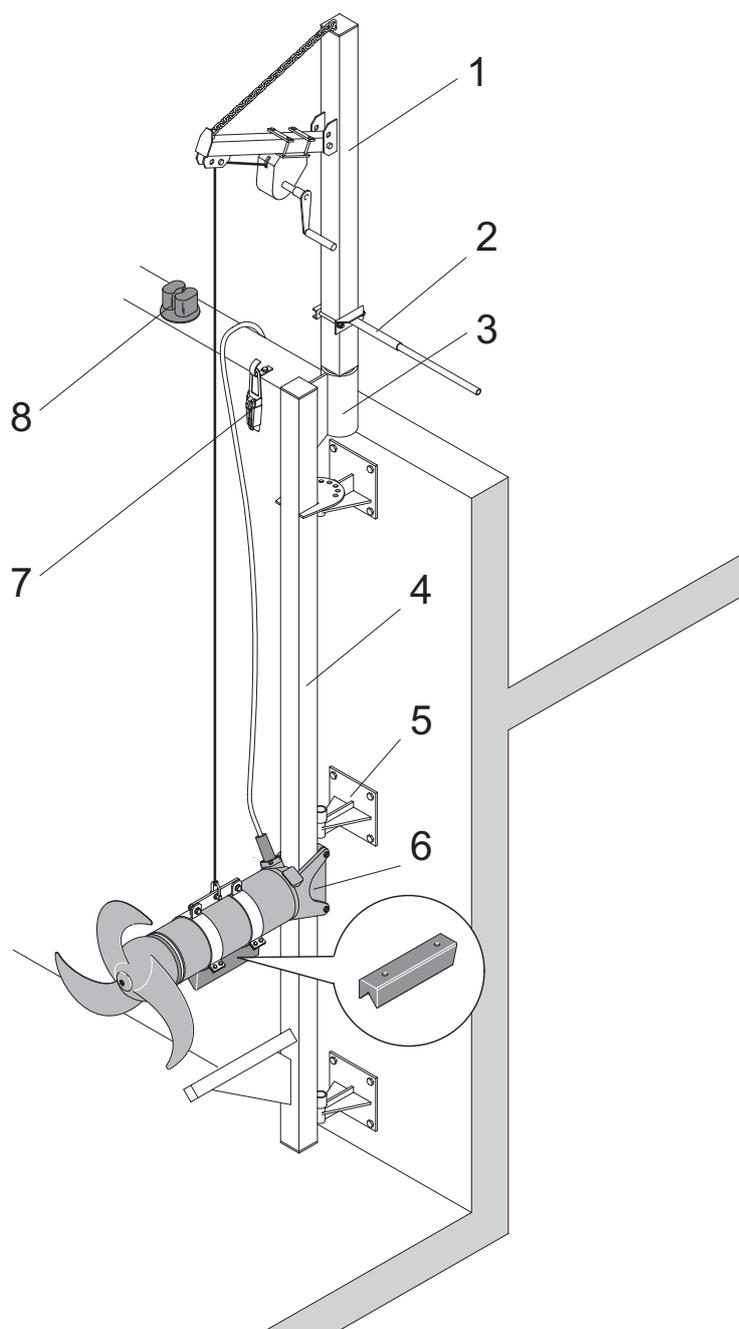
Esempio di installazione con altre possibilità di fissaggio
